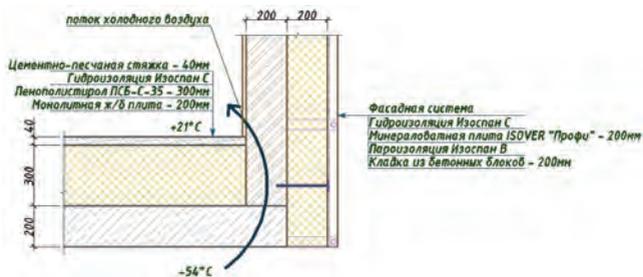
узел утепления стыка наружных стен с цокольным перекрытием.
